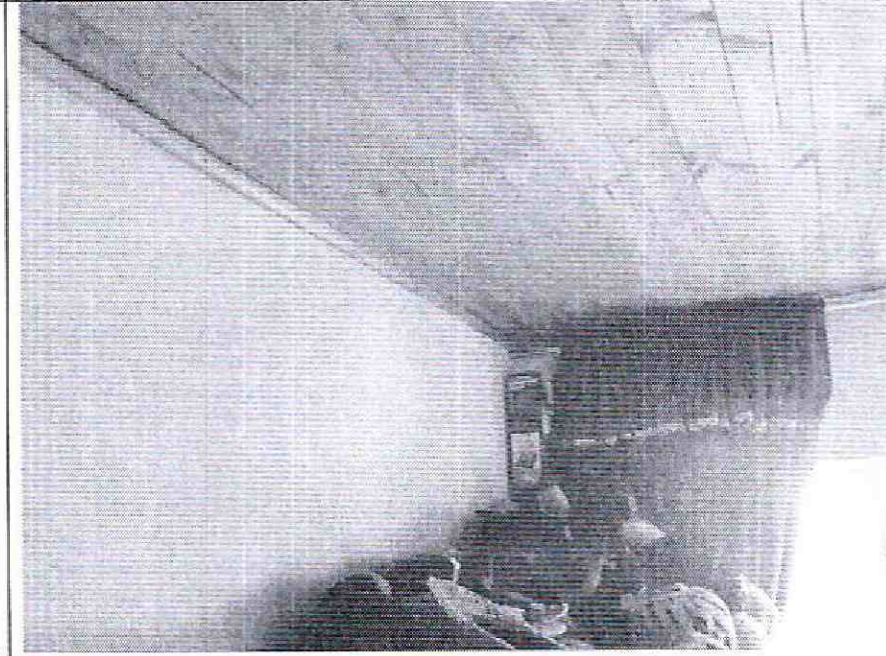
Cielo raso bajo cubierta, no se evidencia daño.
